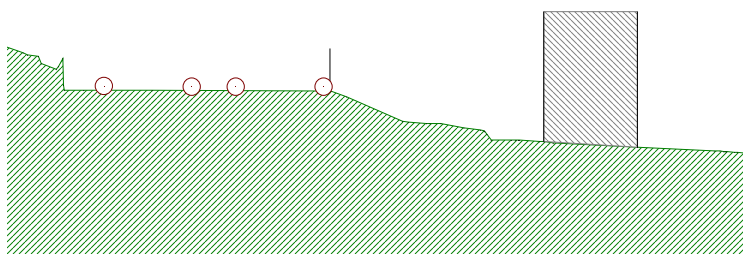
Esquema de implantação da Barreira Acústica 6
